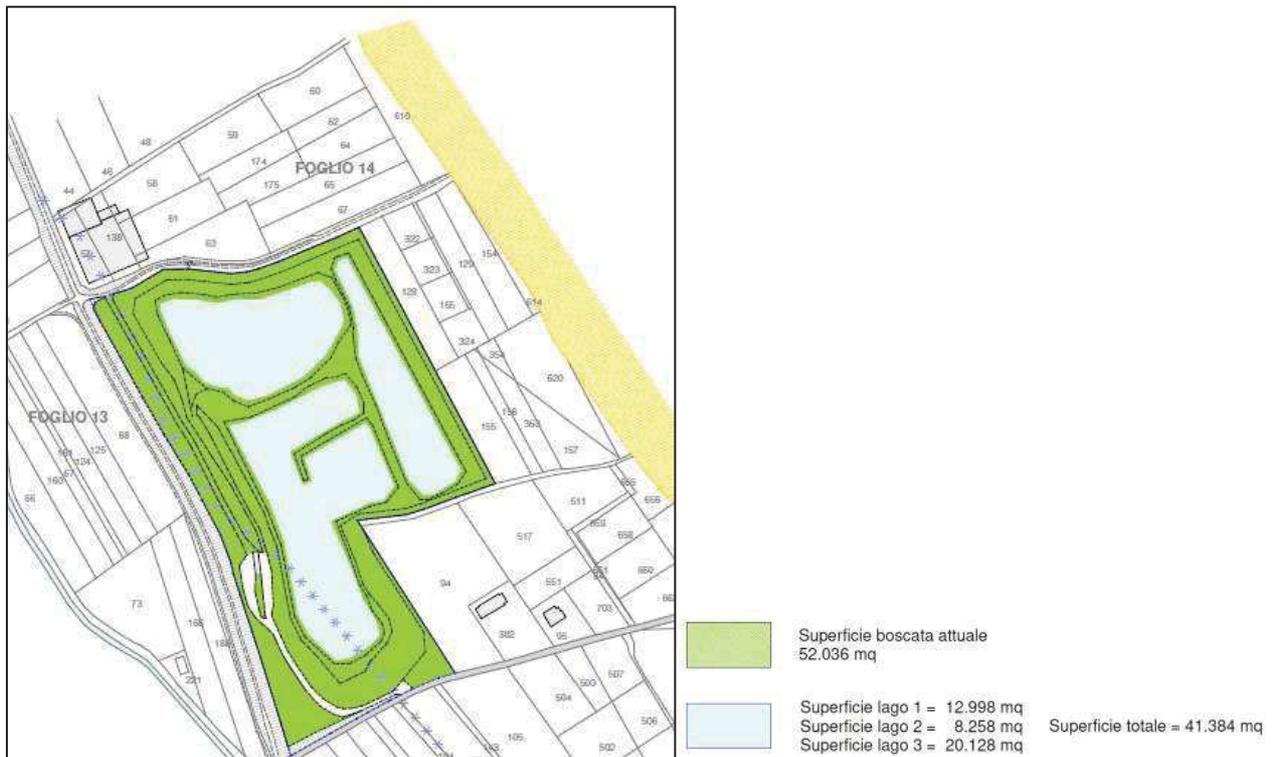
Estratto planimetria con indicazione della superficie boscata attuale
